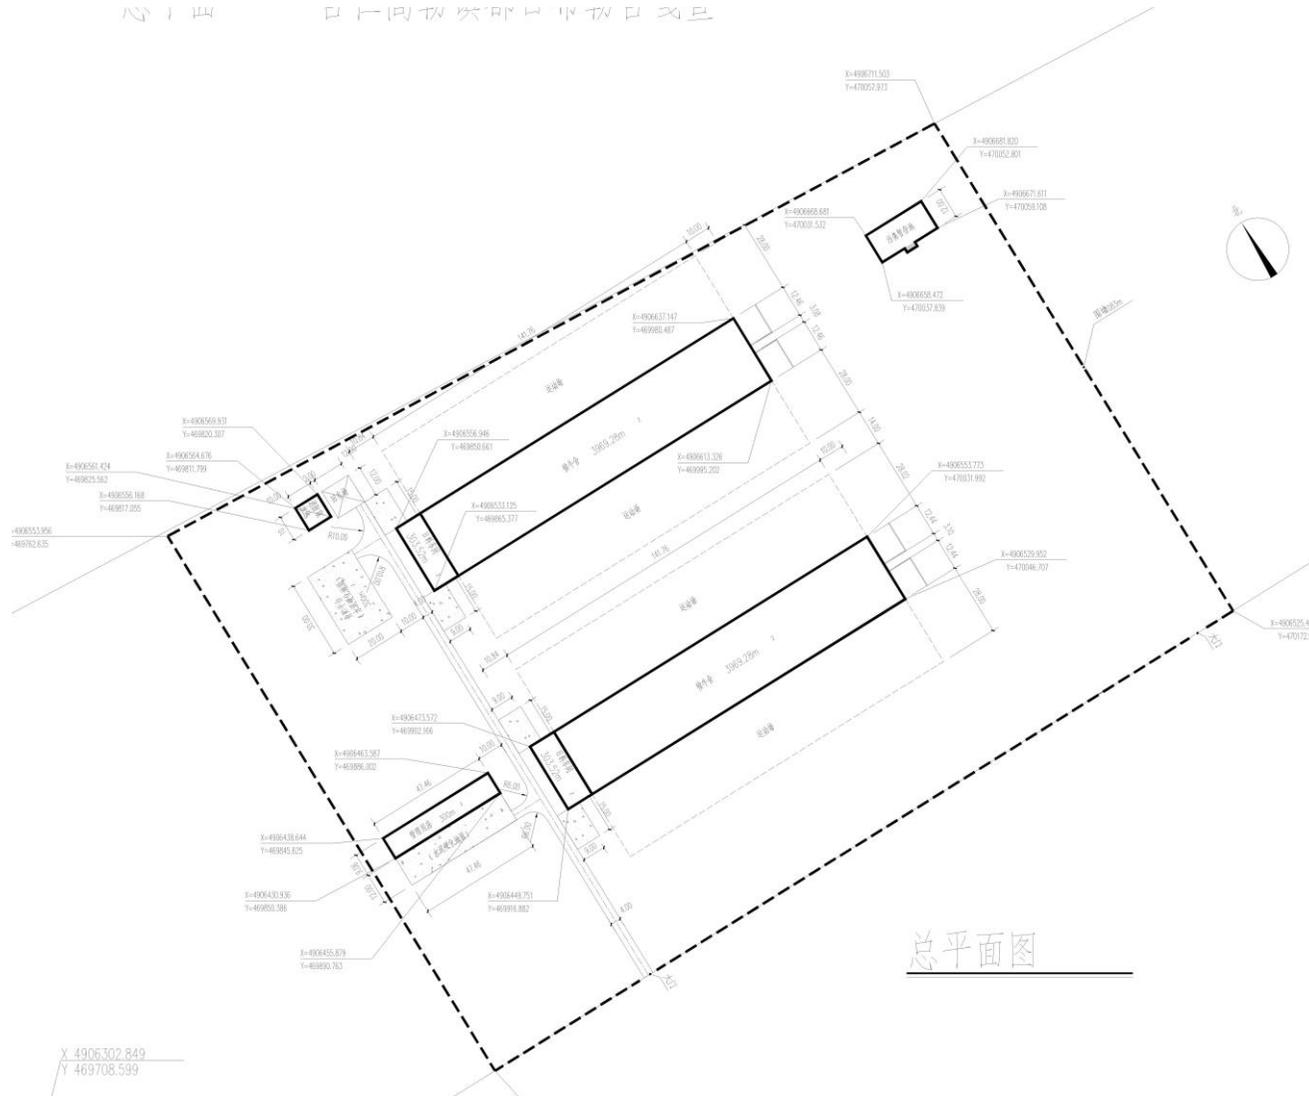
(2) 都日布勒吉养殖区平面布置图
